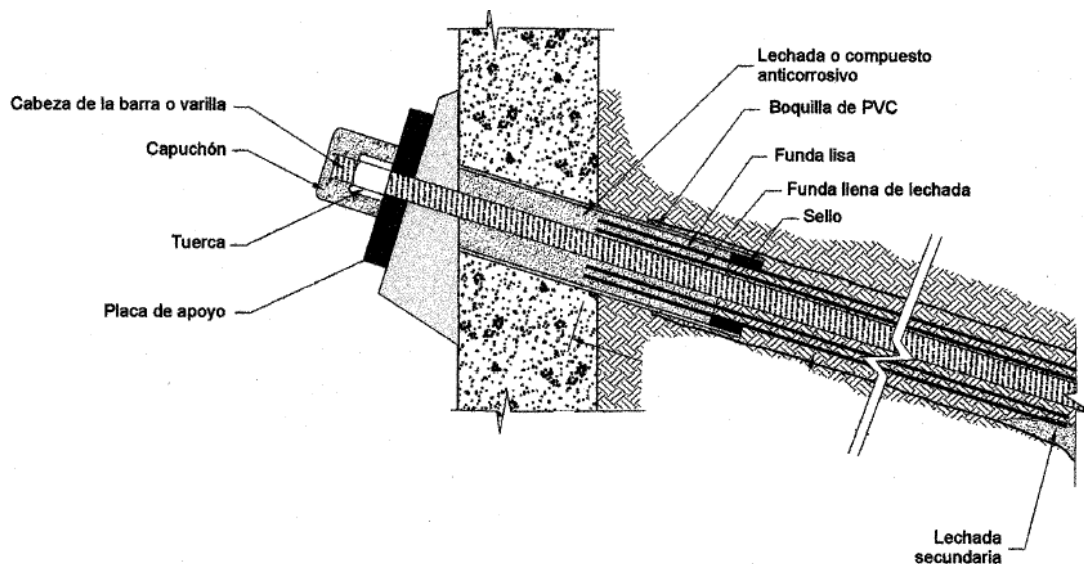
Dispositivos y elementos de protección en la cabeza de sistemas de anclaje
